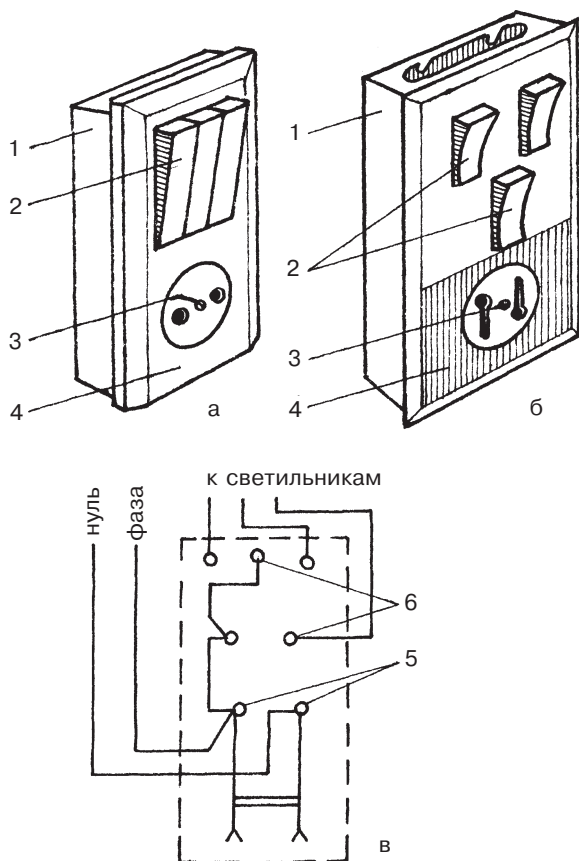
Блок выключателей с розеткой: а — марки БВР3; б — марки БСУЗ; в — схема присоединения (1 — коробка; 2 — клавиша выключателя; 3 — крепежный винт; 4 — крышка; 5 — контактные зажимы розетки; 6 — контактные зажимы выключателей)
